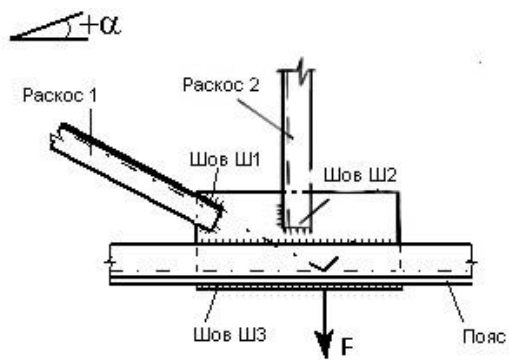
«Конструкторский чертеж узла номер 2» [10]
